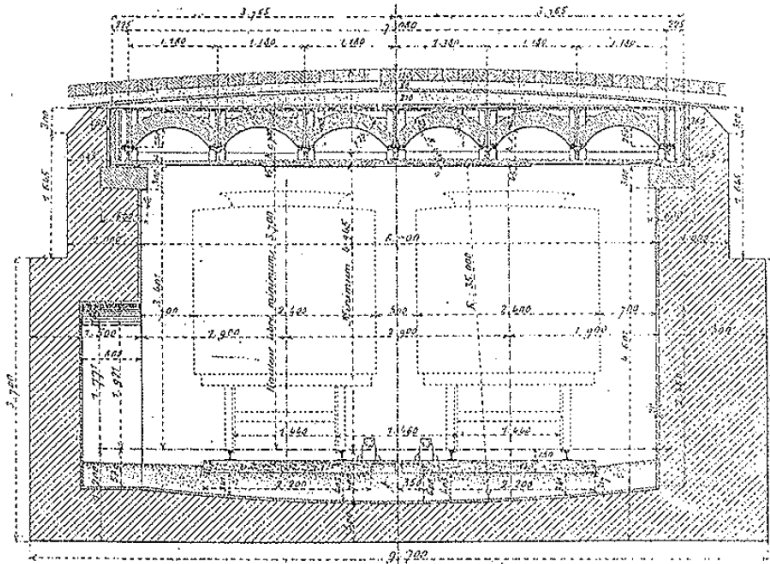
Section transversale d'une tranchée couverte en tablier mixte (acier et brique). (Biette, 1903).
